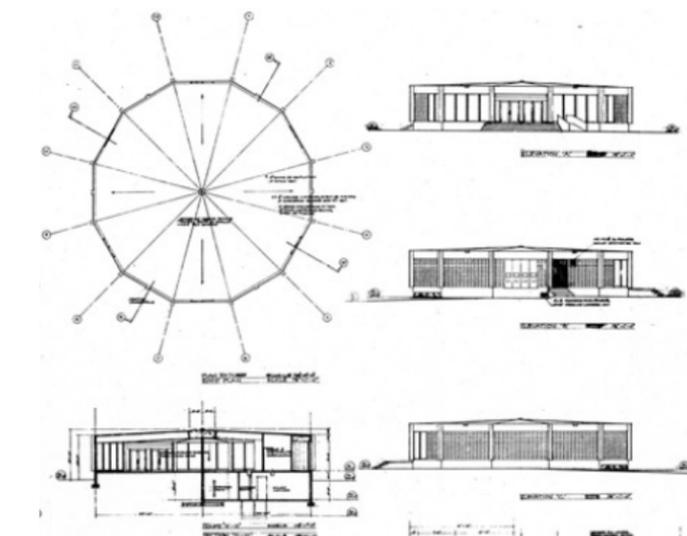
Plan et élévations du pavillon des services bancaires, 1966
